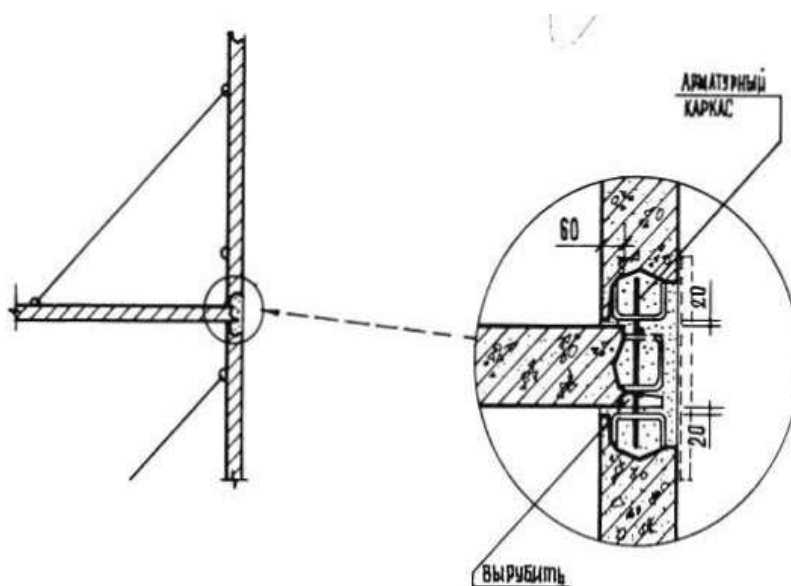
Схема установки и монтажный узел диафрагмы жесткости, устанавливаемой в торце перекрытия
